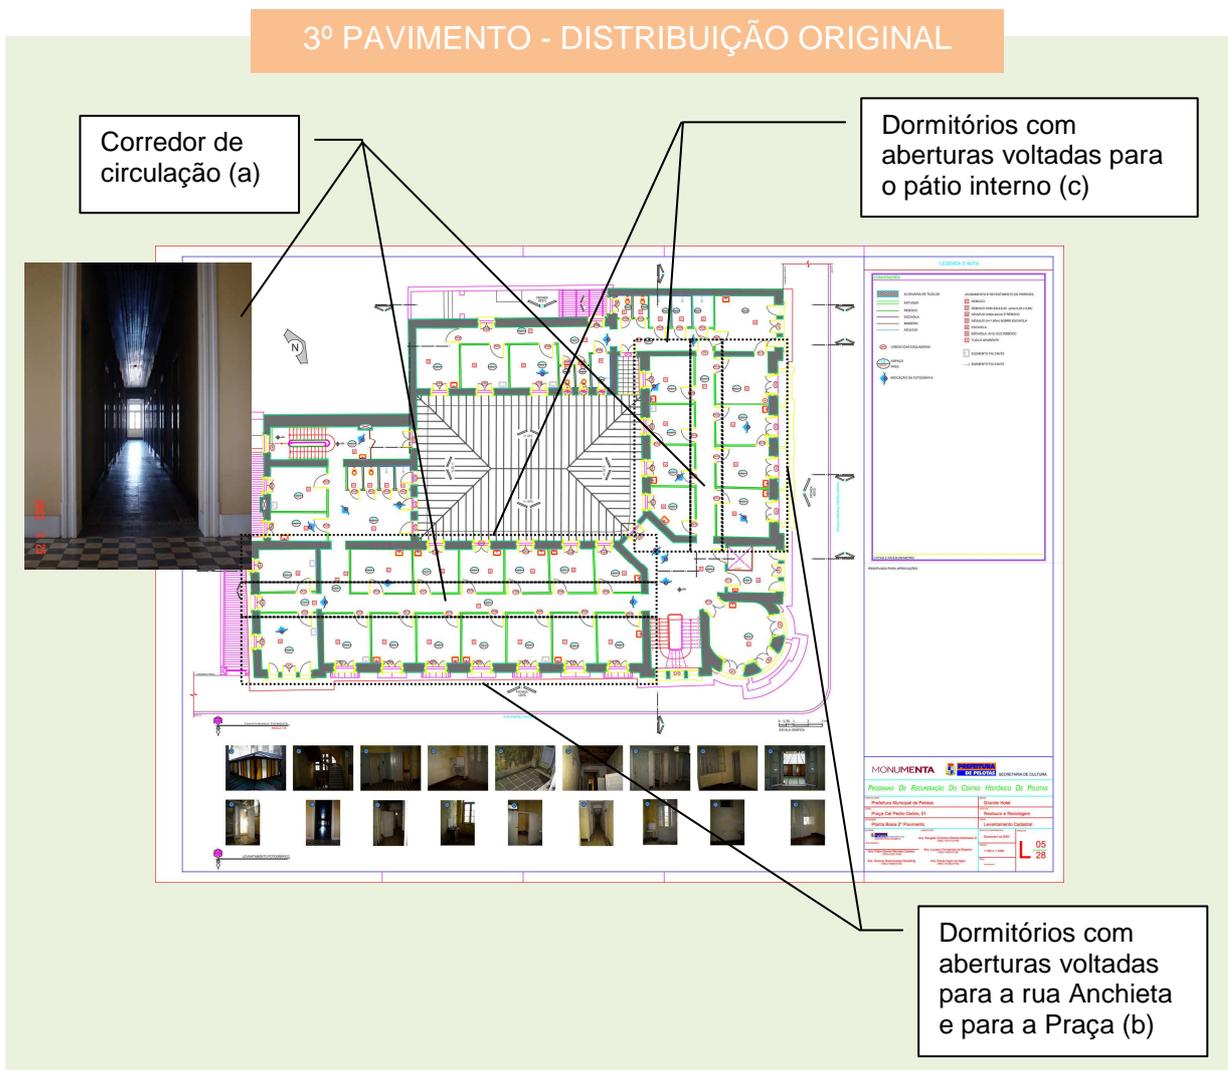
Indicações sobre a planta baixa do 3º pavimento original.
